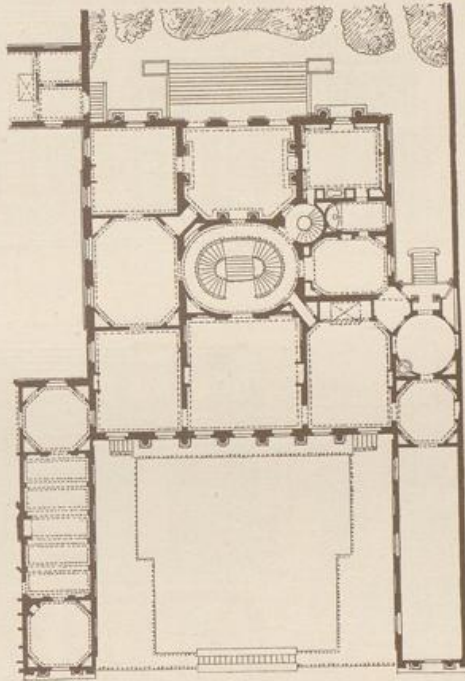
Grundriss des Hauses St. Foix et Carenne in Paris (n. Krafft u. Ransonette).
